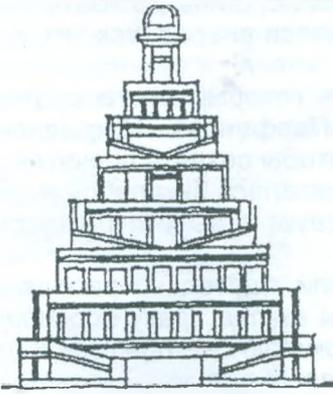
Святилище бога Мардука в Вавилоне (Вавилонская башня). Фасад, план
